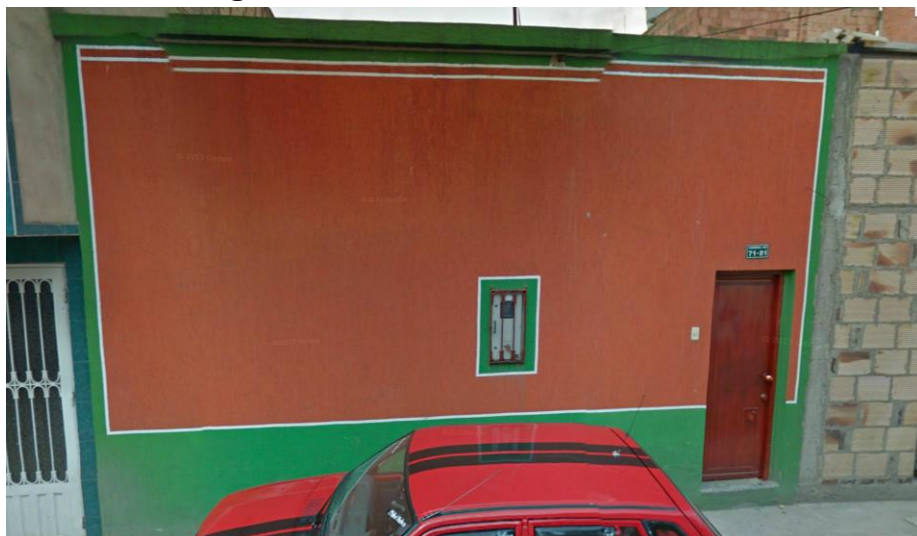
Vivienda UPZ 87 -Tintal Sur-
